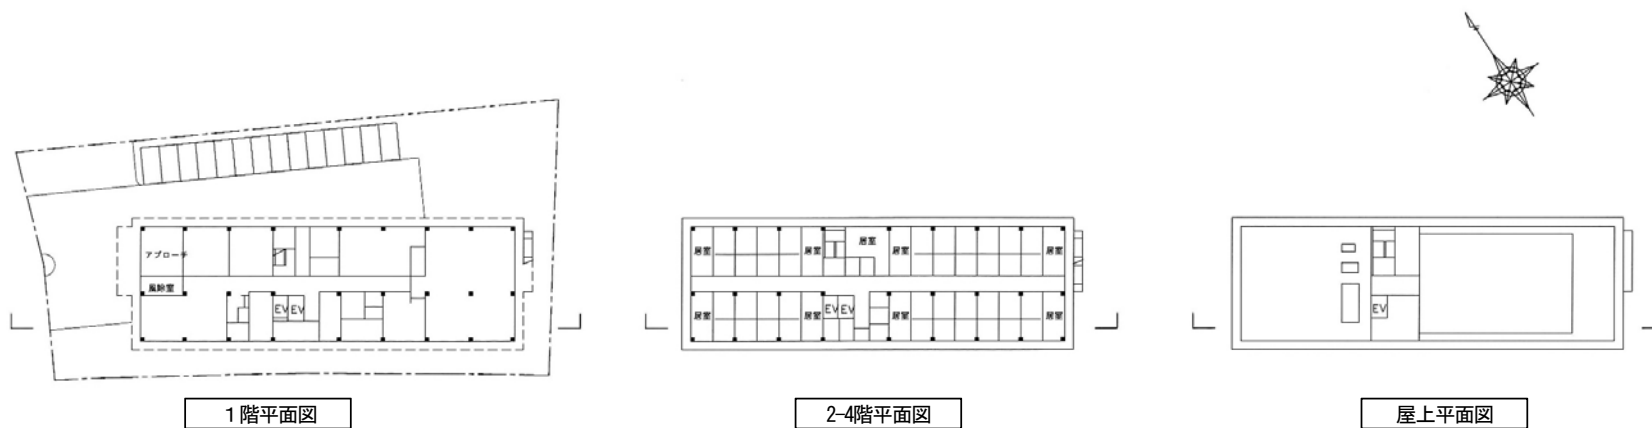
(1) 施設平面図 (住宅型有料老人ホーム)
